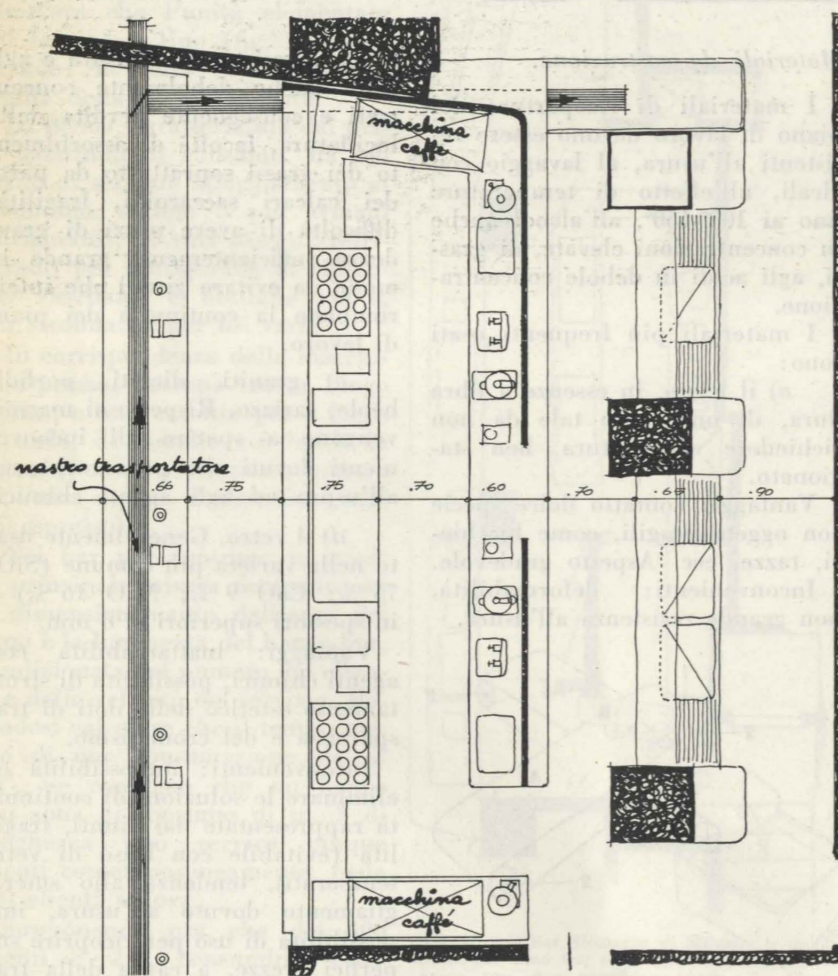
Pianta d'insieme del Bar Motta di Milano (Arch. M. Bega).
